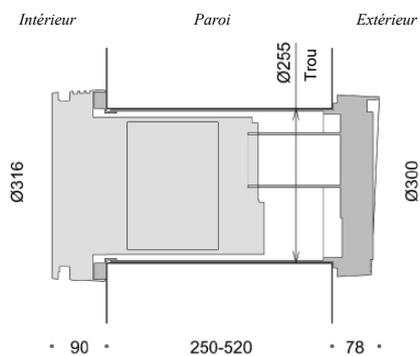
Dimensions. Toutes les dimensions sont en [mm]
